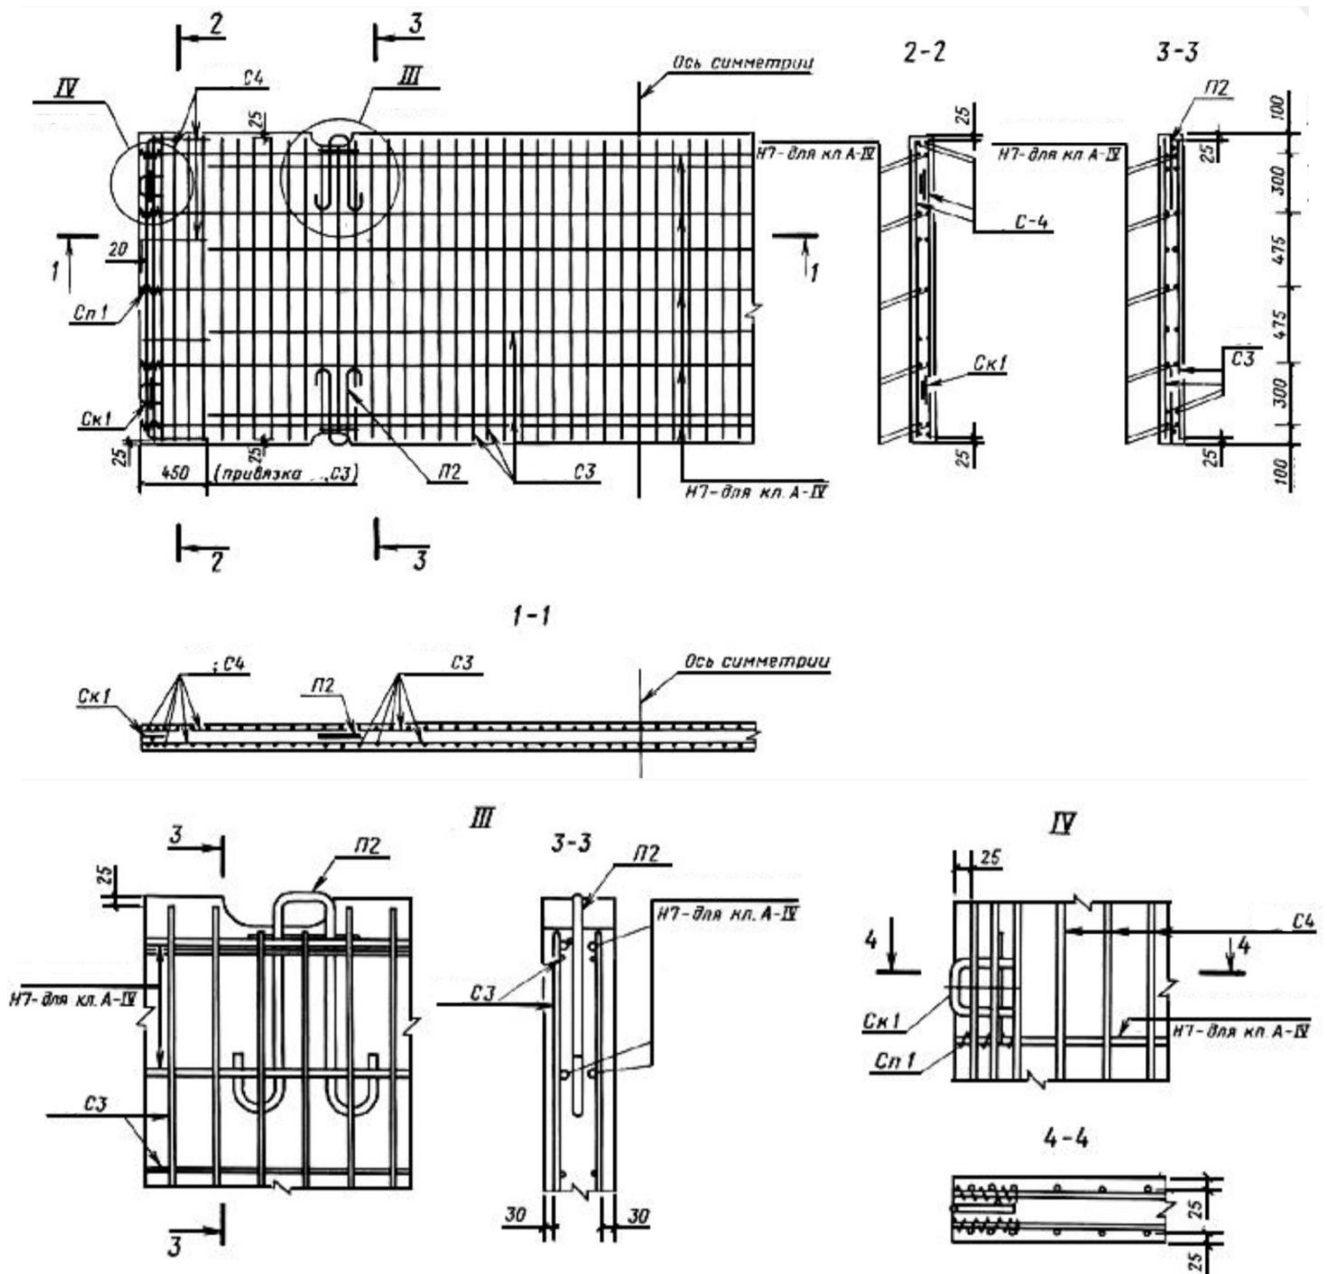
Схема армирования предварительно напряженной дорожной плиты 1П60.18-30АІV
